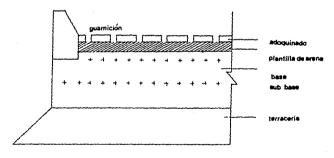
Sección típica de un pavimento de adoquín para tránsito
